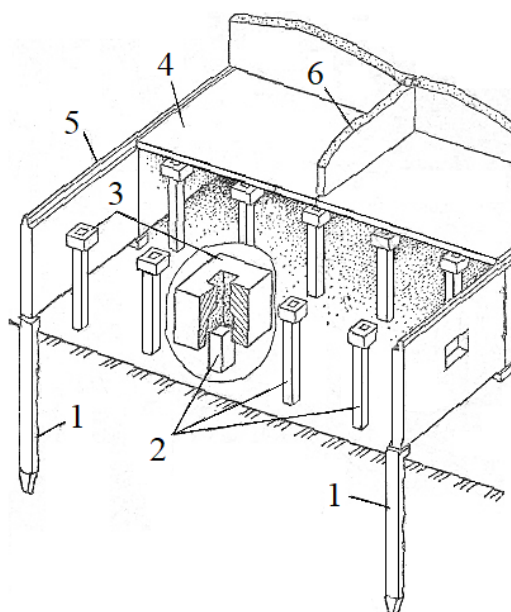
Конструктивные элементы здания на безростверковом свайном фундаменте
